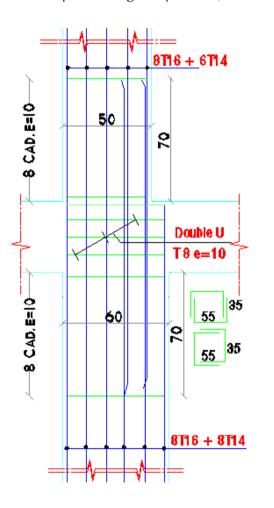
Ferraillage de recouvrement des poteaux (60×40) cm 2 et (50×40) cm 2 .
